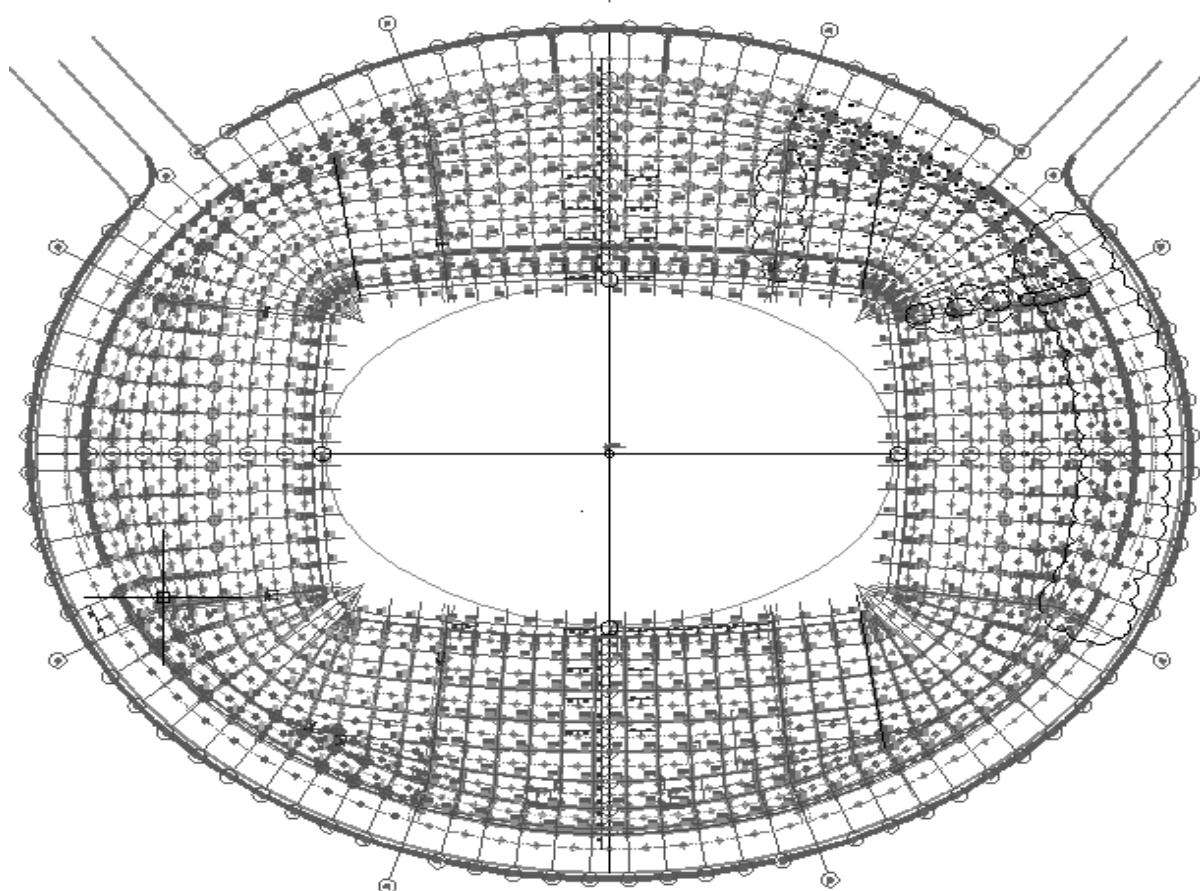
План размещения армирующих элементов в основании трибун стадиона
